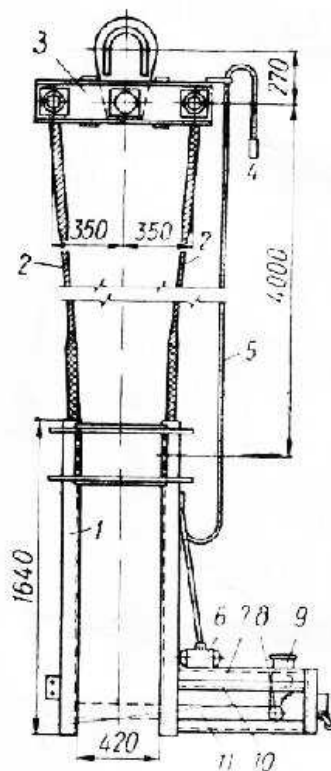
г – Полуавтоматический захват для монтажа колонн
